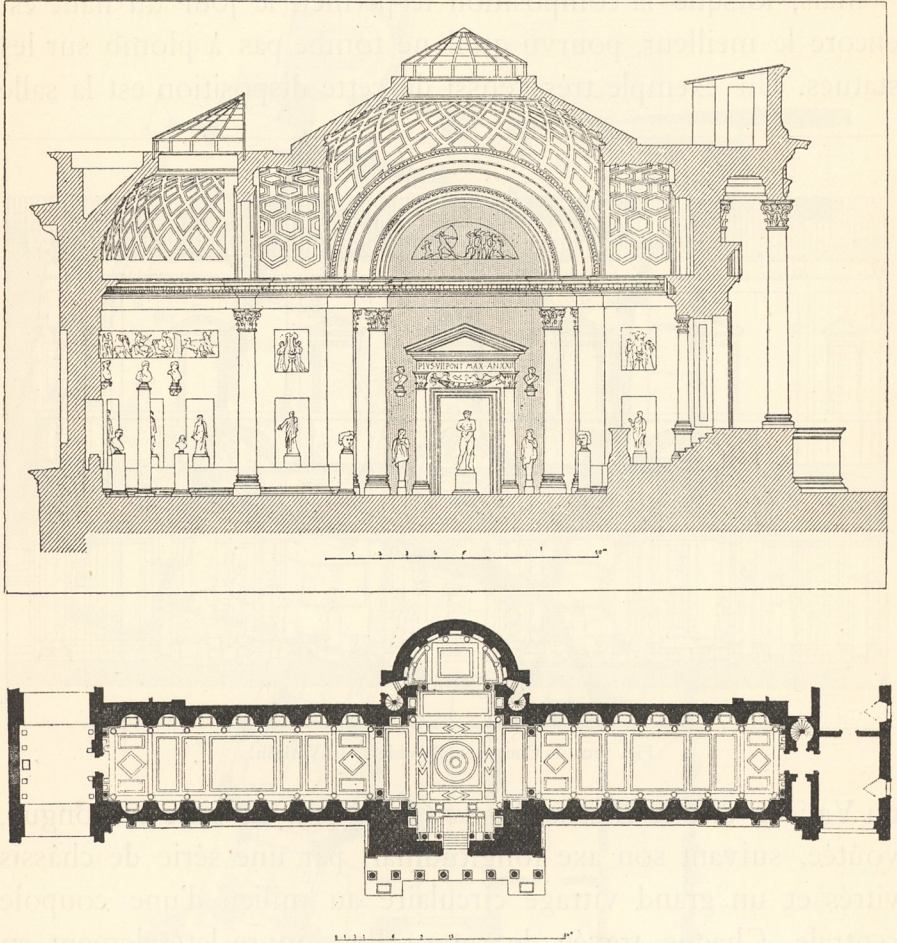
Plan et coupe de la galerie du *Braccio Nuovo*, au Vatican.
